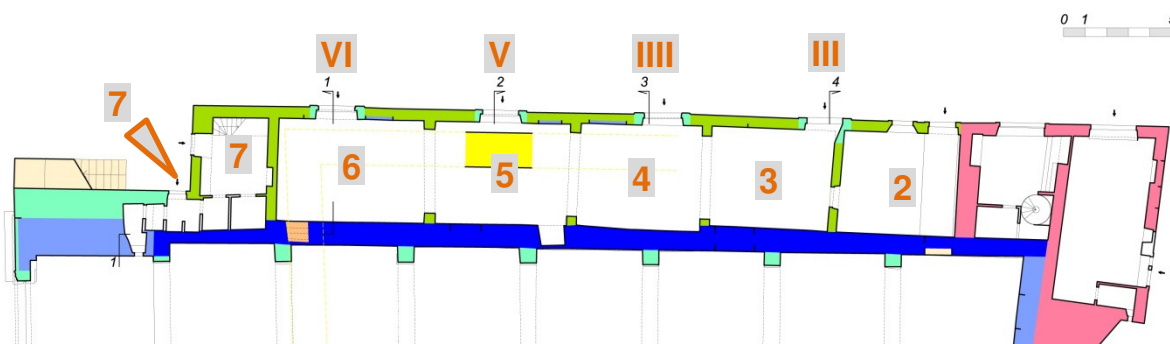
Fontik Grundriss <sup>475</sup>
